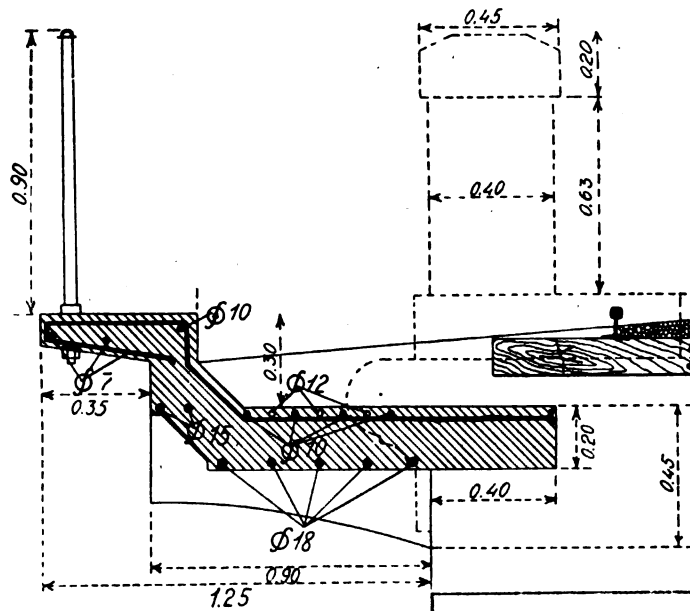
Trave-mensola in calcestruzzo armato. - Sezione.
